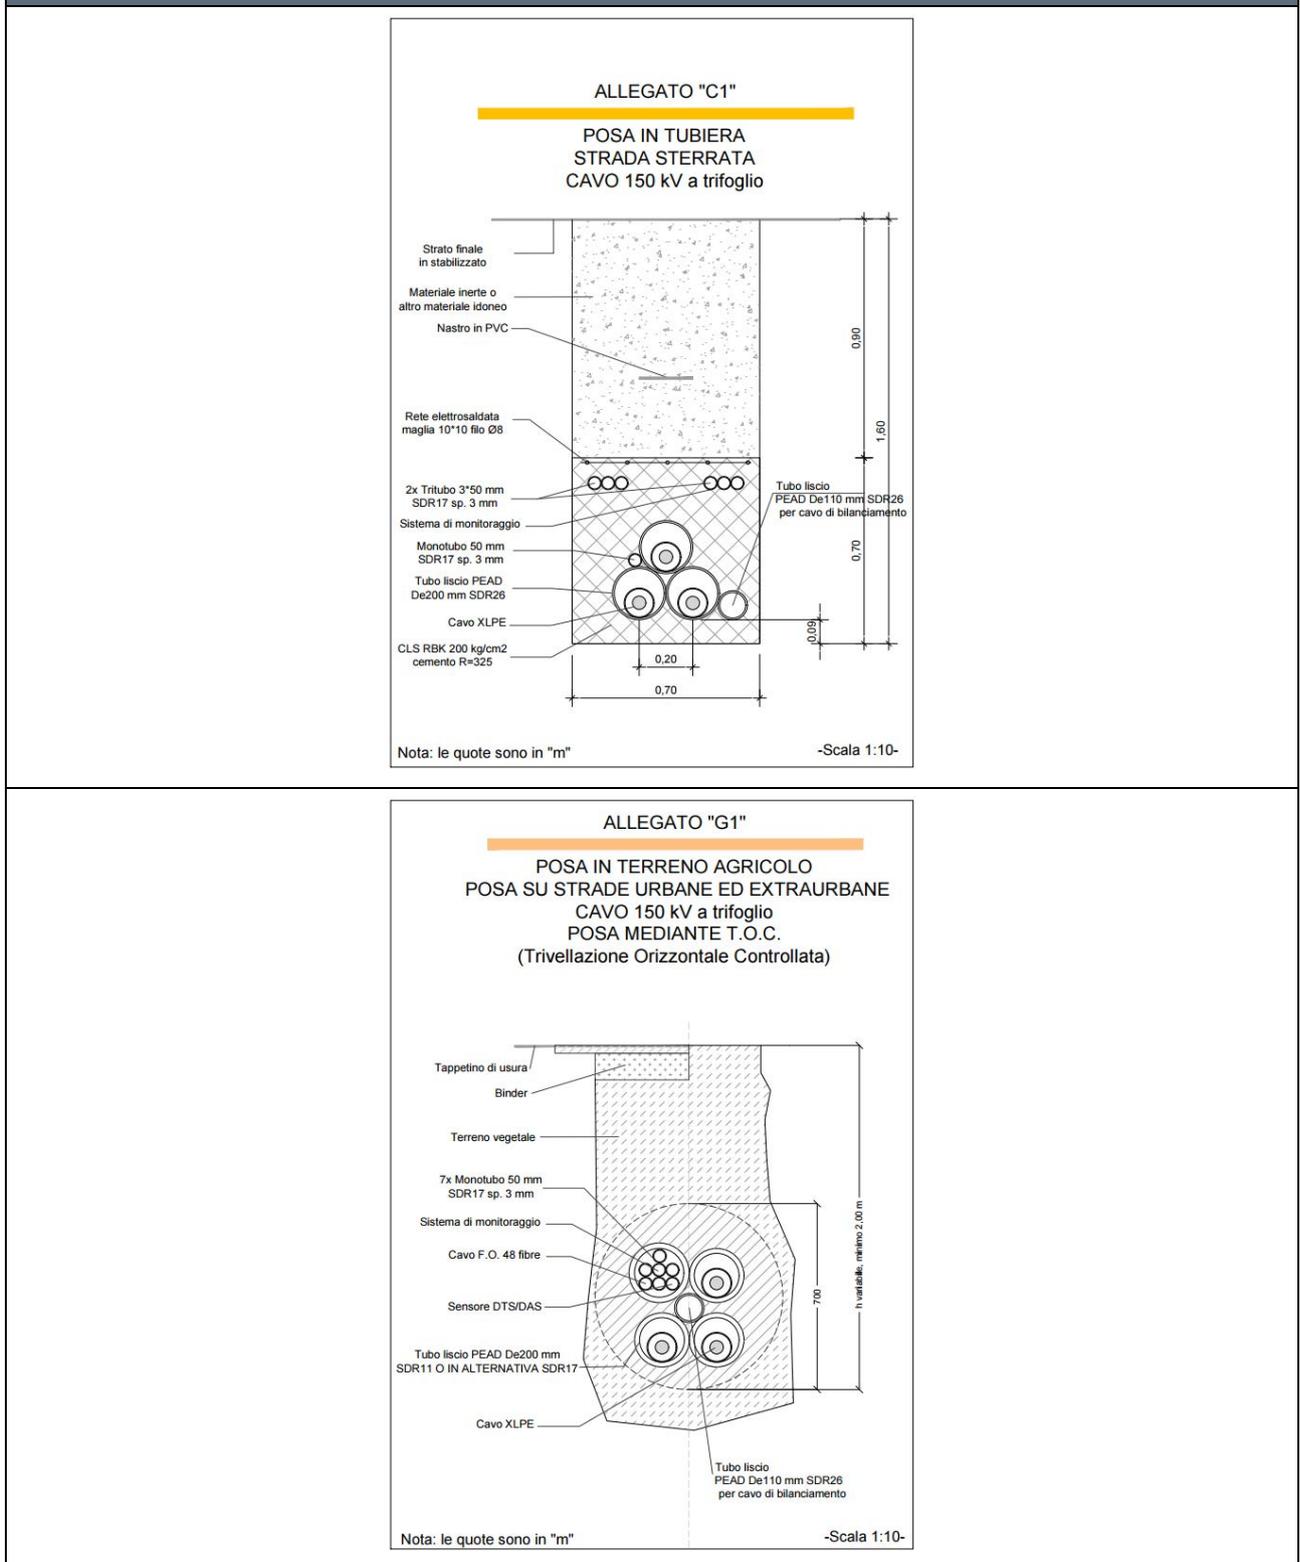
Sezione tipo trincea posa elettrodotto cavo interrato
